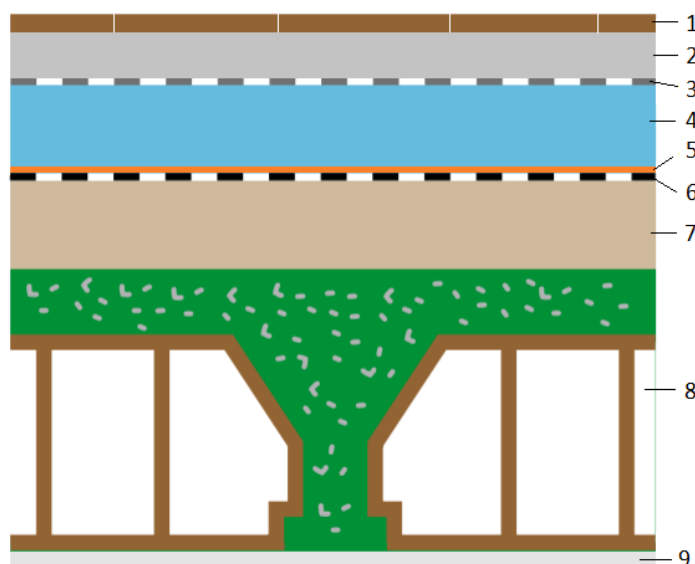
Sección cubierta plana invertida con acabado de pavimento fijo.
